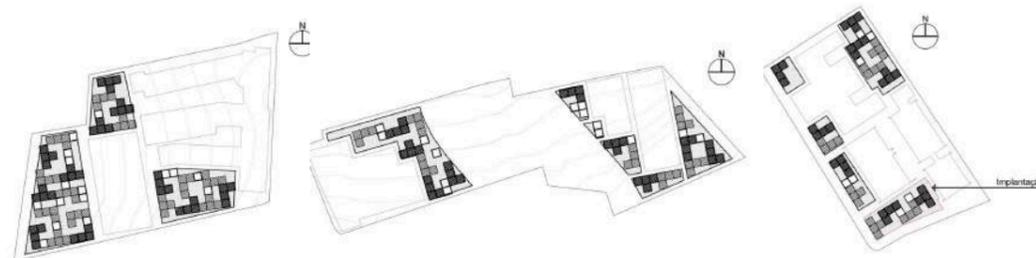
Planta de implantação térreo, s/escala. Fonte: Autoria Própria, 2024.
